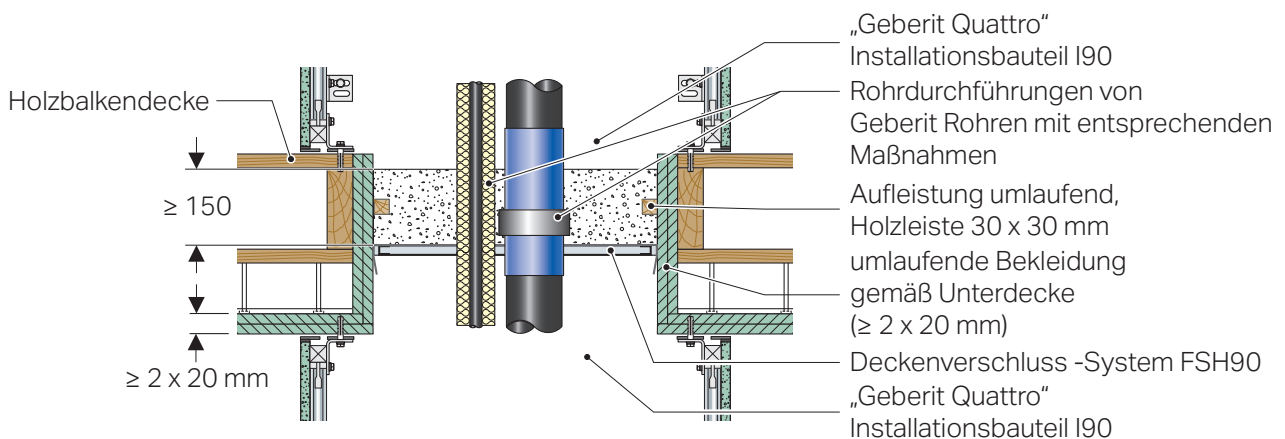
Deckenverschluss-System FSH90 in einem Geberit Quattro I 90-Installationsschacht mit Holzdecke
